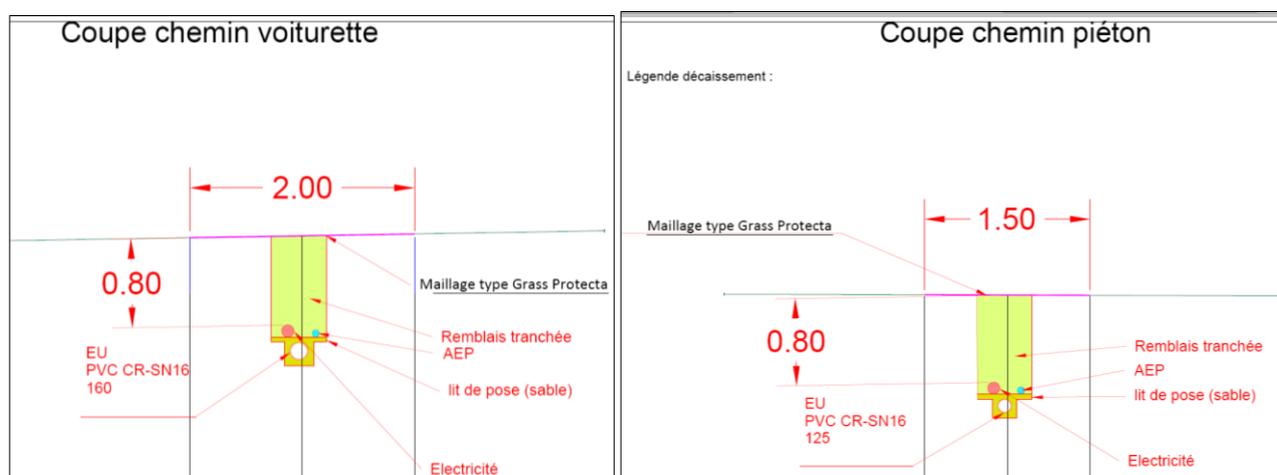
coupe des chemins secondaires et des tranchées réseaux (source : ACP Ingénierie Publique)
